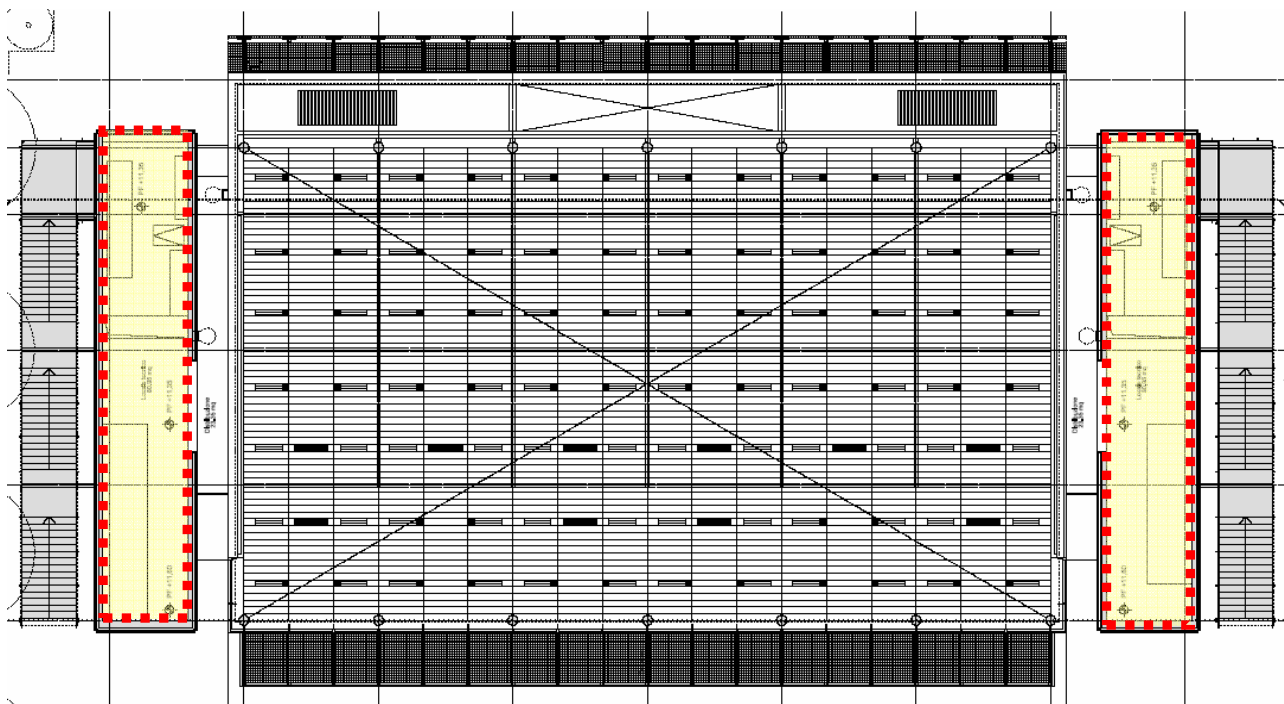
Indicazione in pianta delle zone tecniche dell'edificio
